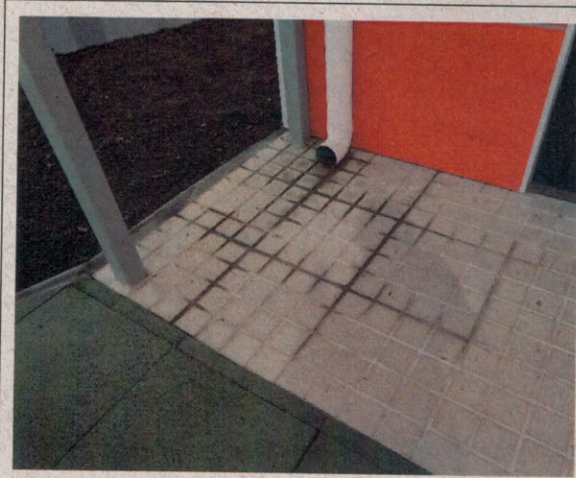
Bajadas de aguas lluvias sobre pavimento de goma, JI Rahue.
